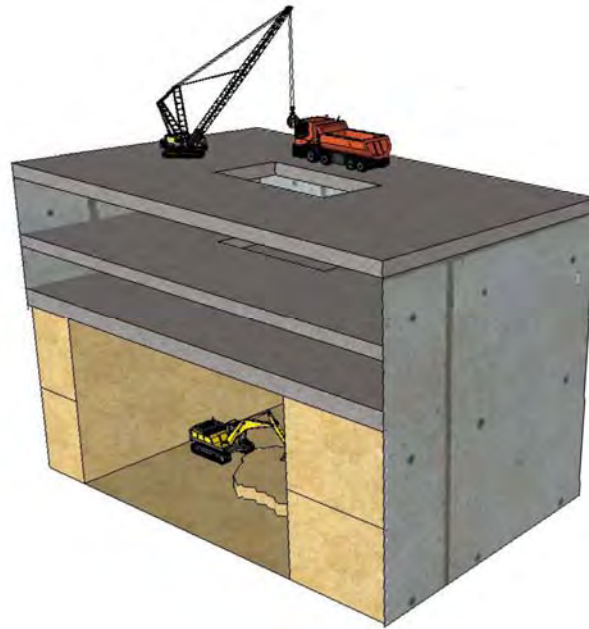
Secuencia para construcción sótano cuatro y tres.
